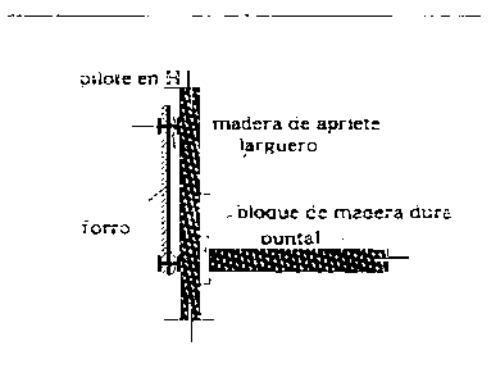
Sección transversal en apuntalamiento típico de excavaciones profundas de frente retenido por pilotes H y forro.
